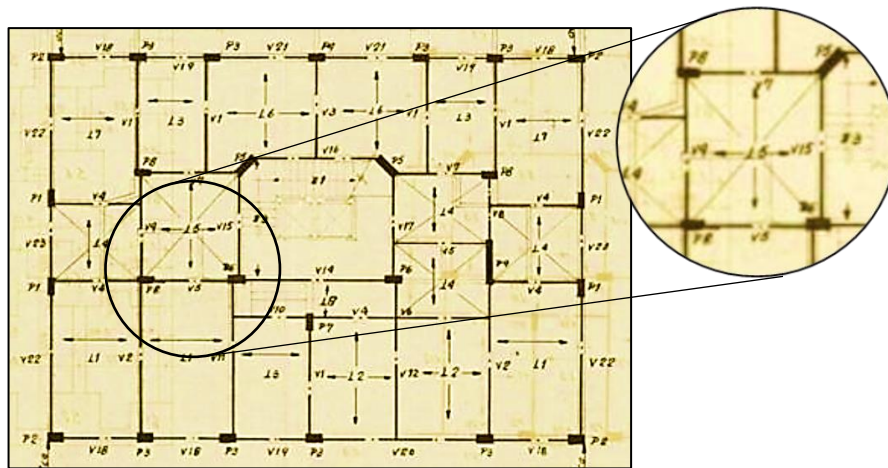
Pormenorização da planta com destaque na falta de alinhamento das vigas
